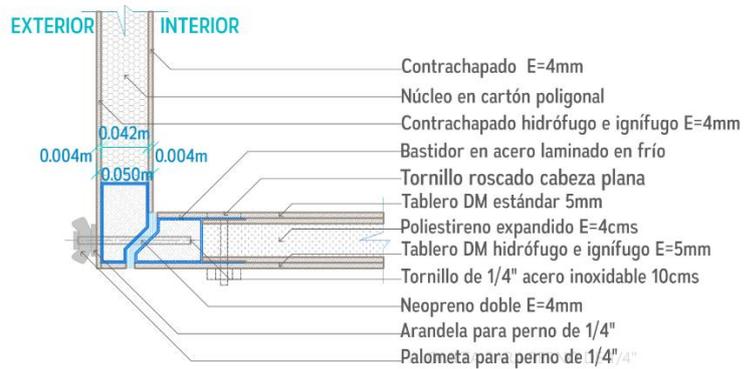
, Detalle en sección de anclaje entre panel vertical y suelo, fuente: Autor.
